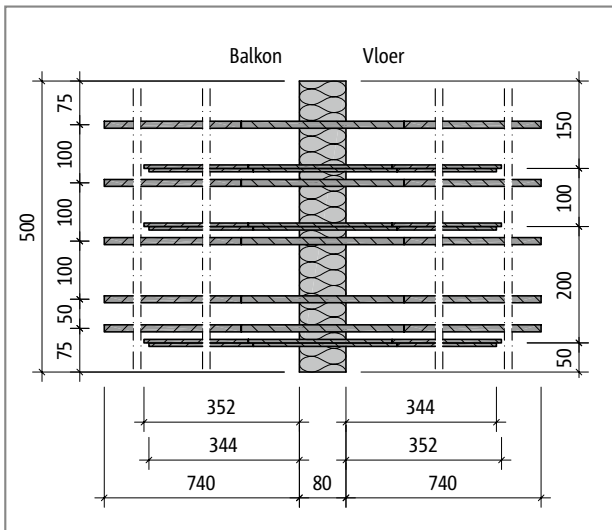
Schöck Isokorb® T type D-MM5-VV3: Overzicht
